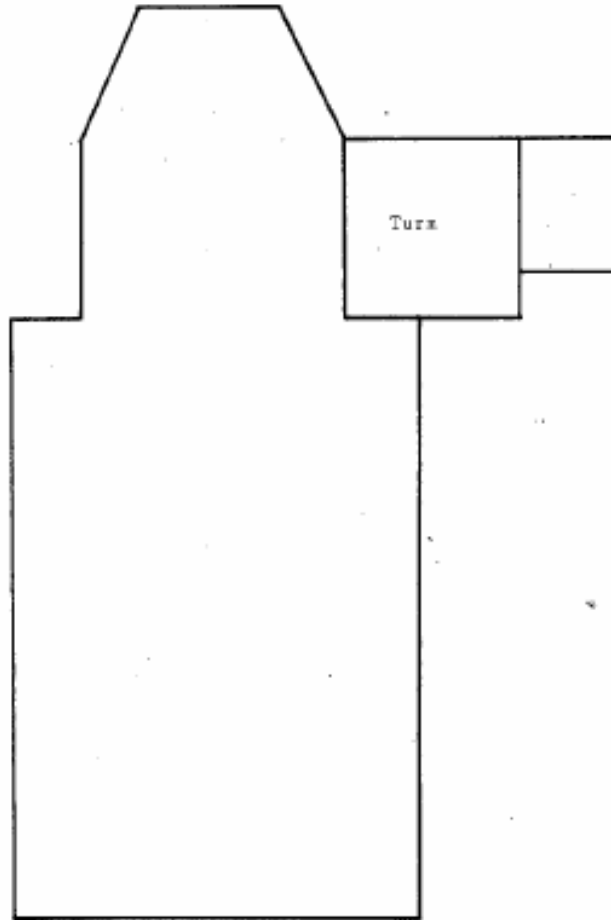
Abb. II: Grundriss des Kirchenneubaues 1745
